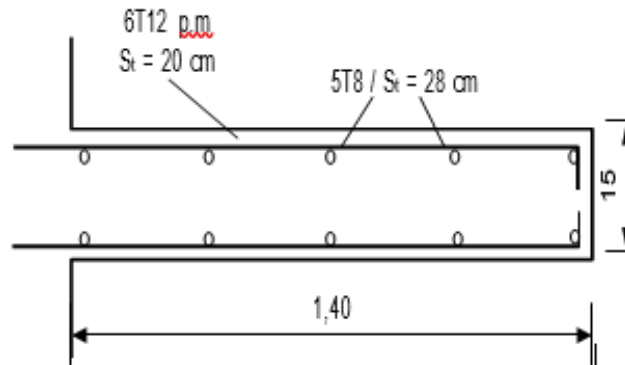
Coupe type d'une section transversale du ferrailage d'un balcon
